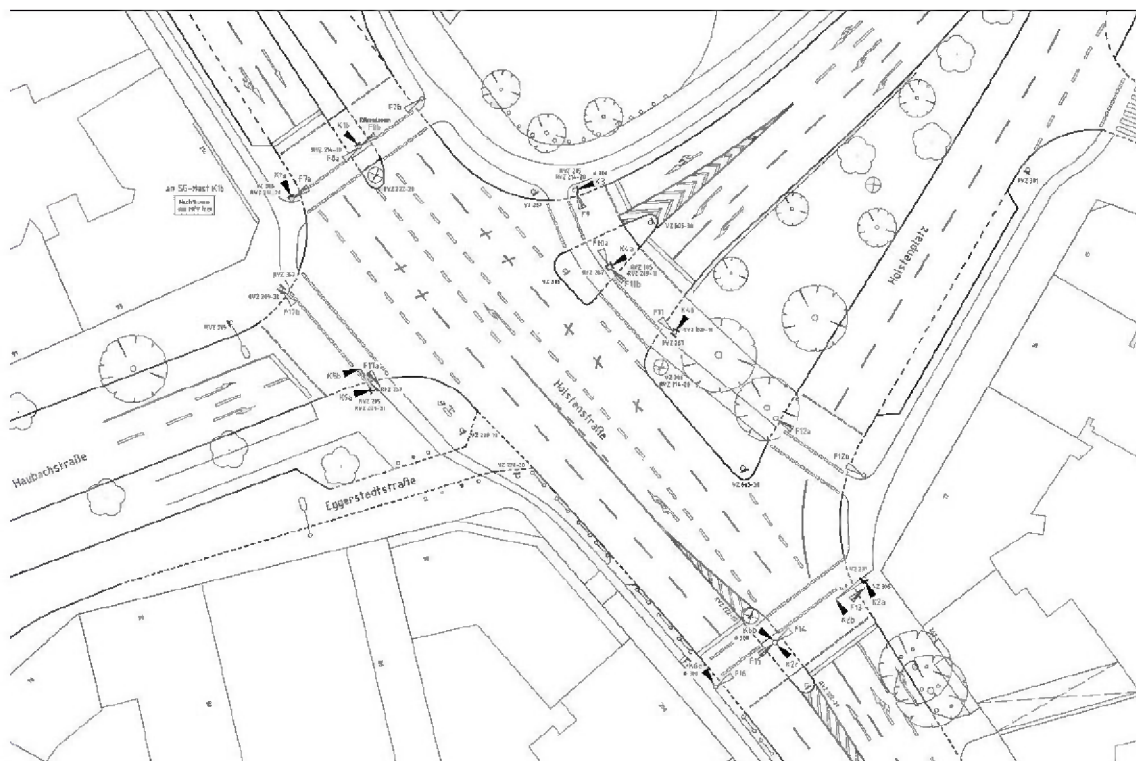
Signallageplan Holstenstraße/Holstenplatz – Bestand (13/600-04-06/00)
